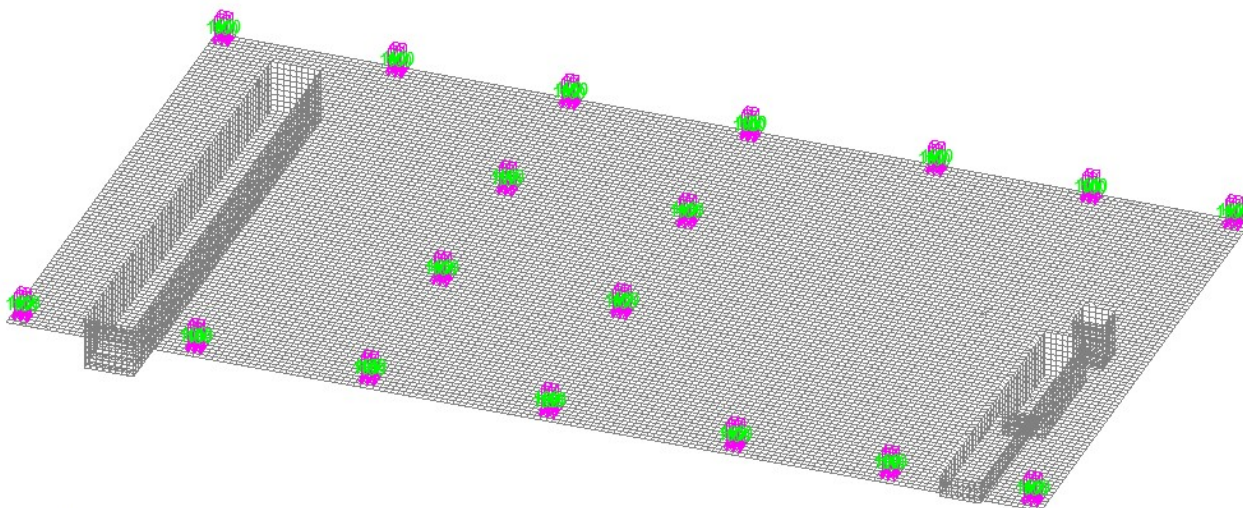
нагрузки на фундамент от каркаса здания
